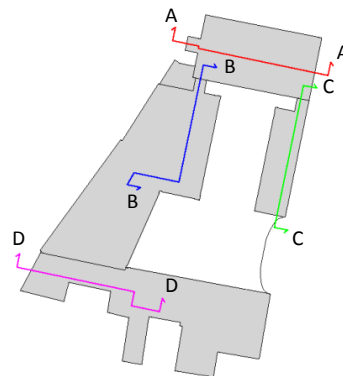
Planivolumetrico con indicazione delle sezioni
